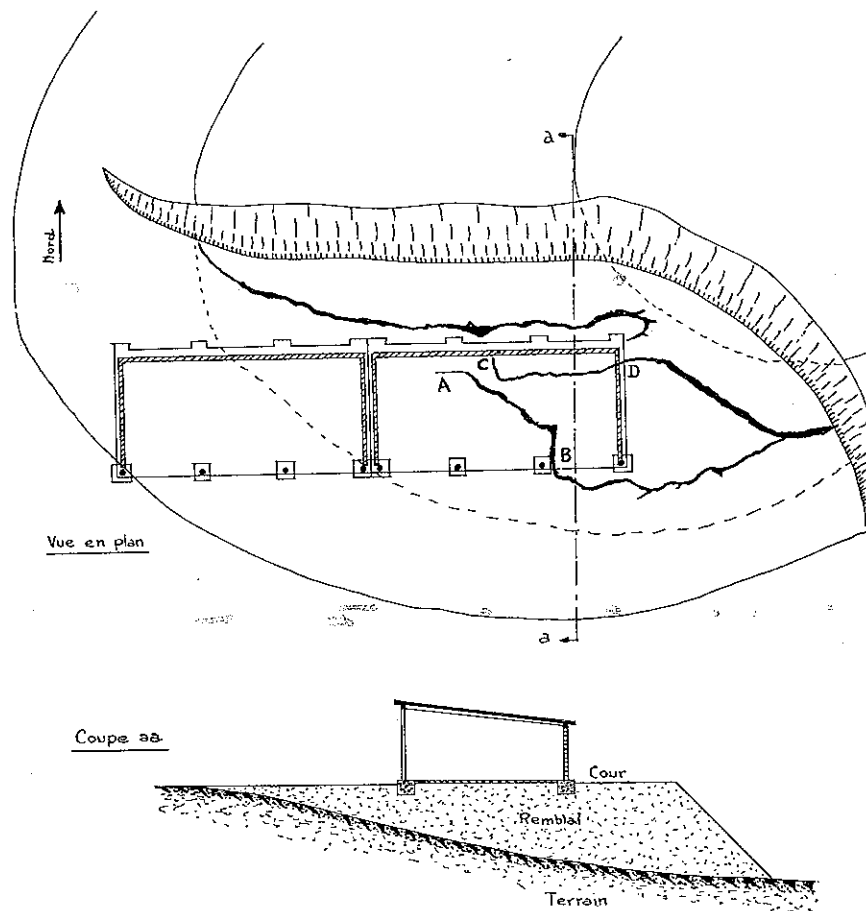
Effondrement d'un préau fondé sur un remblai.
